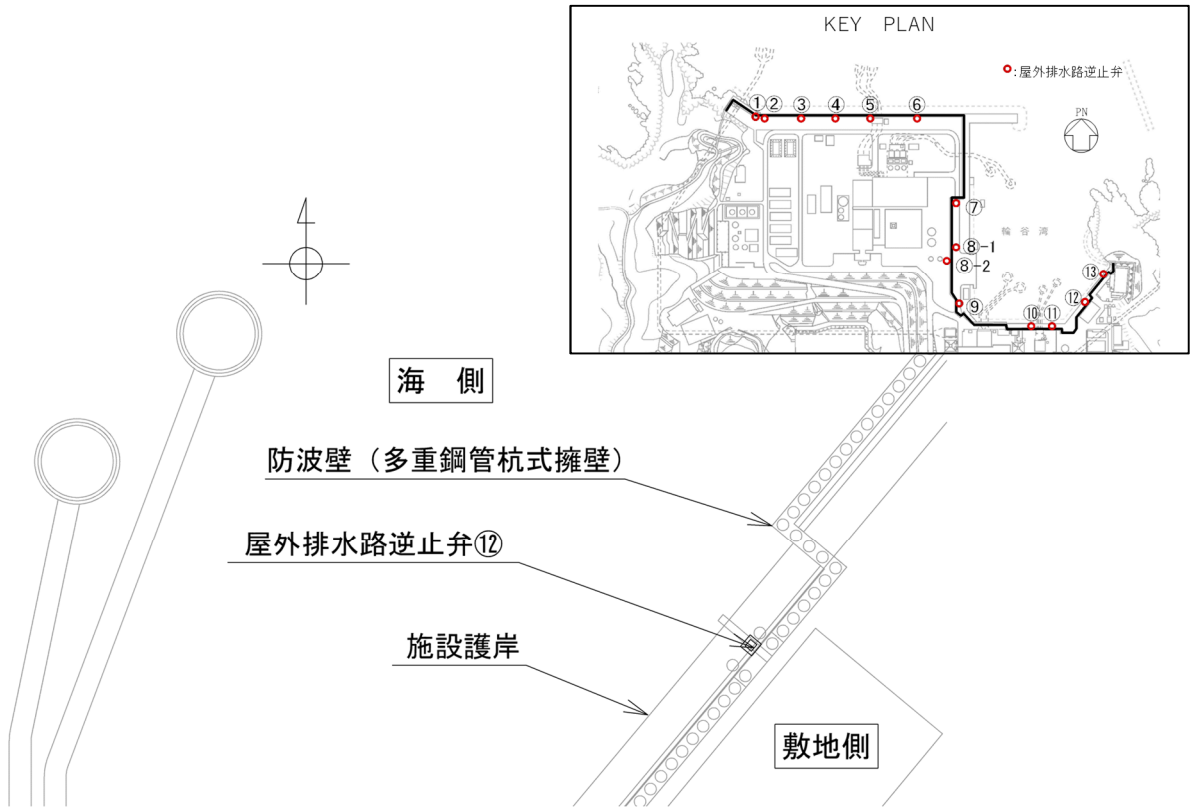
(1) 屋外排水路逆止弁 12 平面图
